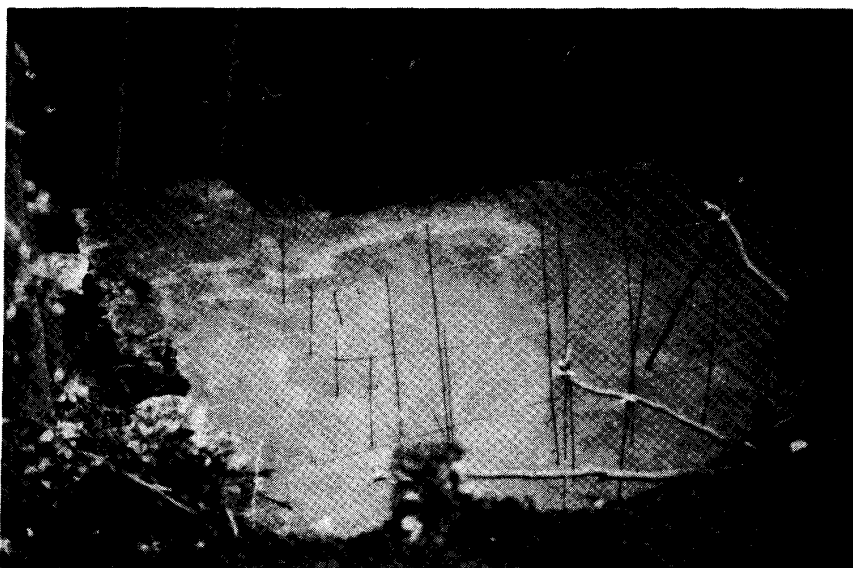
量水堰堤基礎部および湛水池底面のコンクリート打込み
